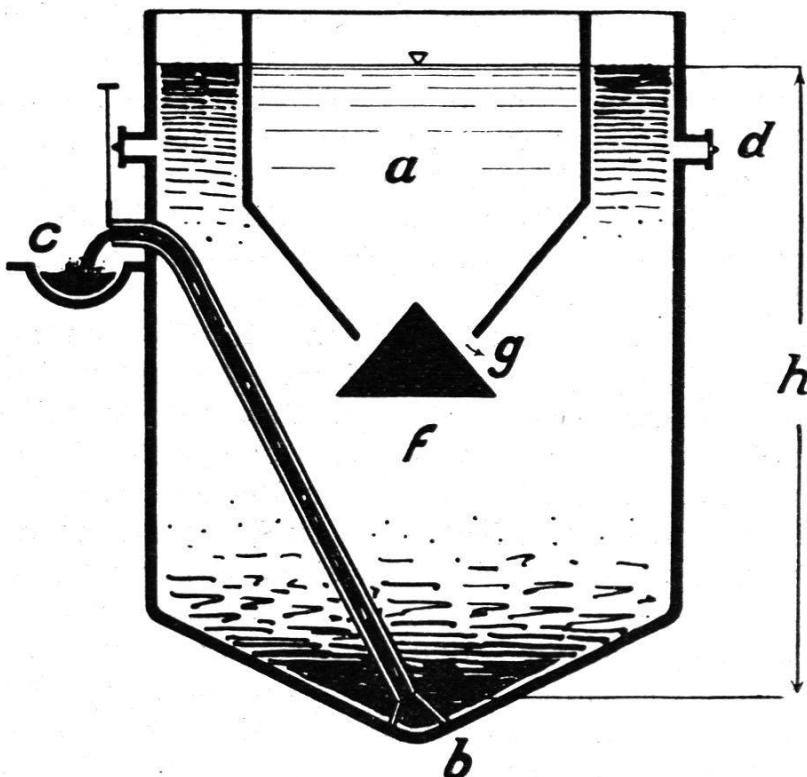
Schematischer Schnitt durch eine zweistöckige Kläranlage.
